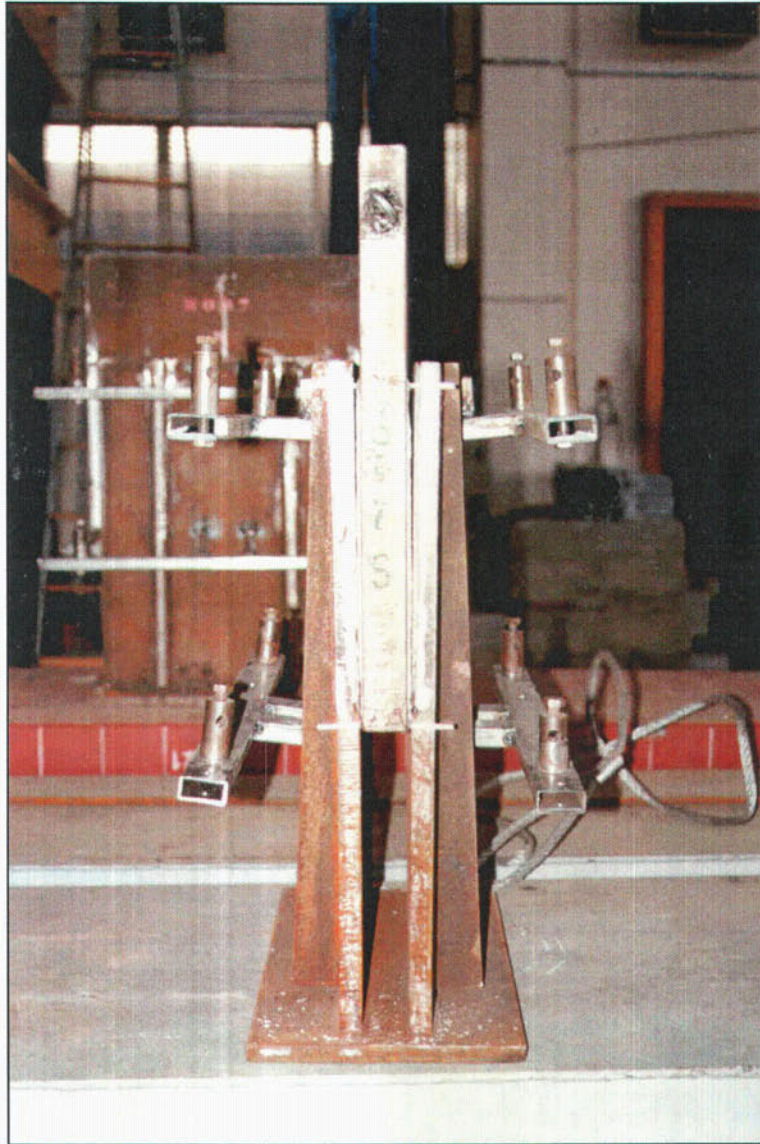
Otro detalle de la probeta 7S ya rota. En esta fotografía se observa nuevamente la rotura de la soldadura 6-8 y la 5-7, completamente arrancadas ambas.
